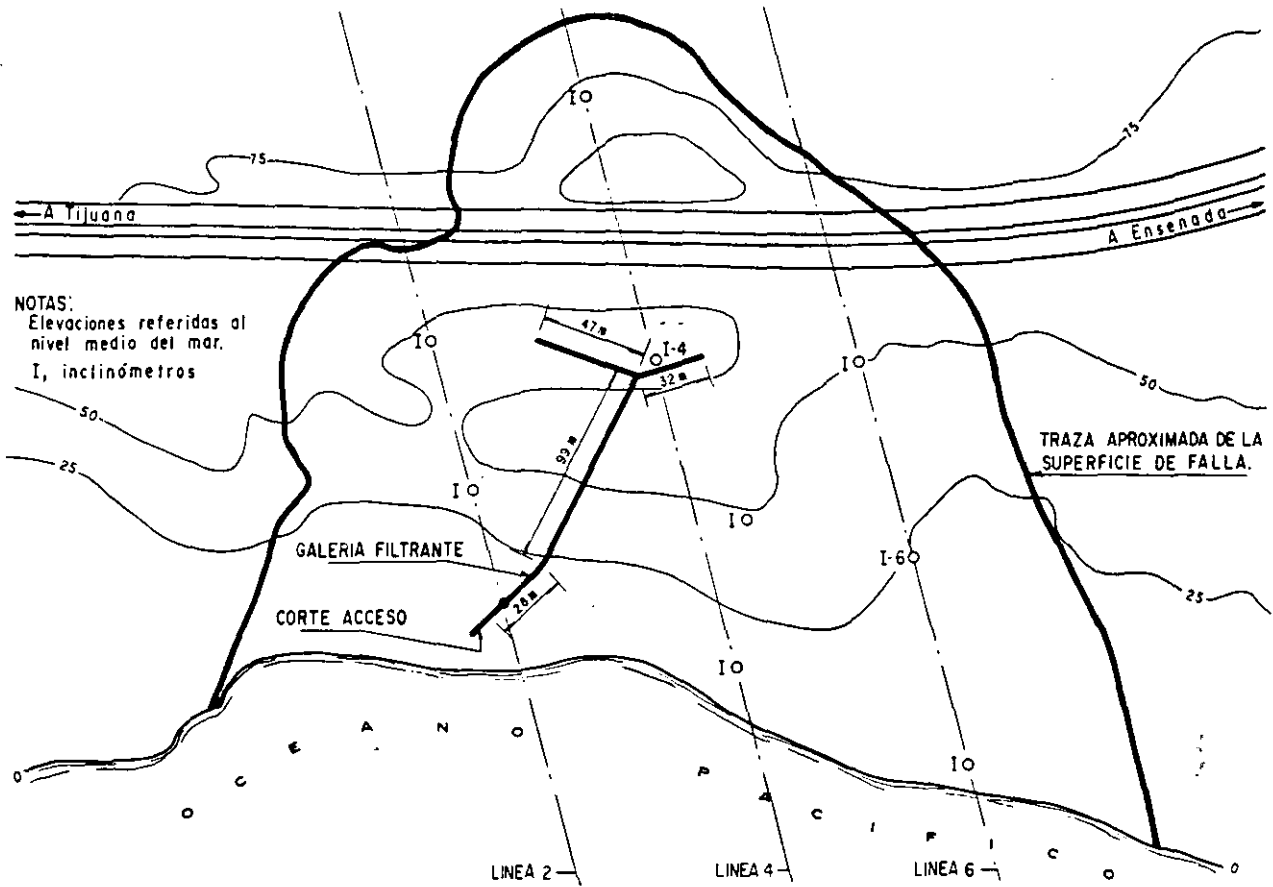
Planta de la galería filtrante del km 15 + 500 de la autopista Tijuana-Ensenada (Ref. 30).
